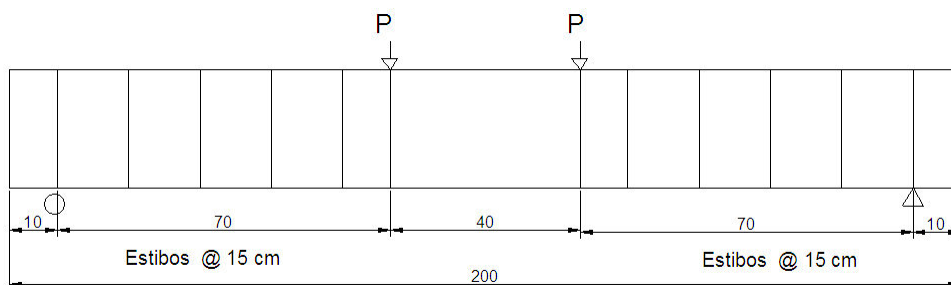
Arreglo de acero longitudinal y transversal de las vigas de referencia.
